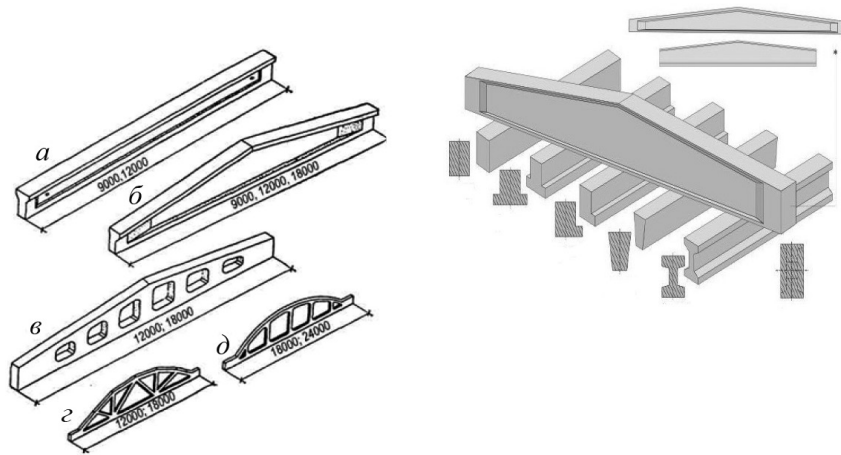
Залізобетонні кроквяні балки та ферми:
